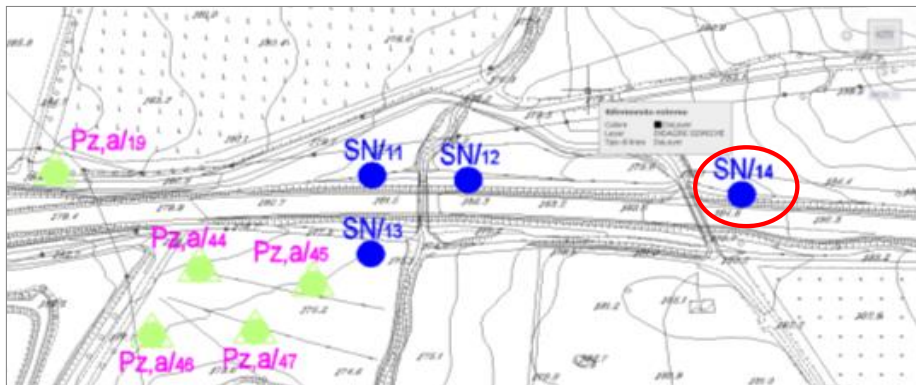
FOTO SATELLITARE CON PROIEZIONE DEL SONDRAGGIO: SN14
